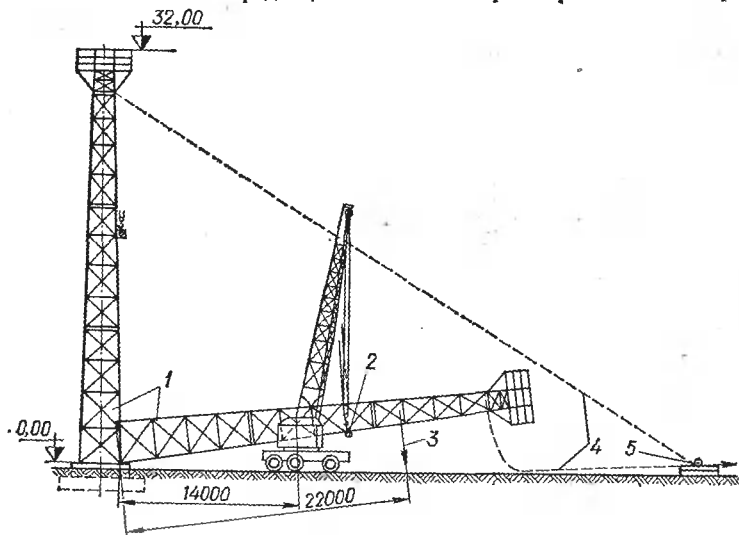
Схема монтажа осветительной мачты высотой 32 м, массой 12 т кранами К-104 и К-123:
